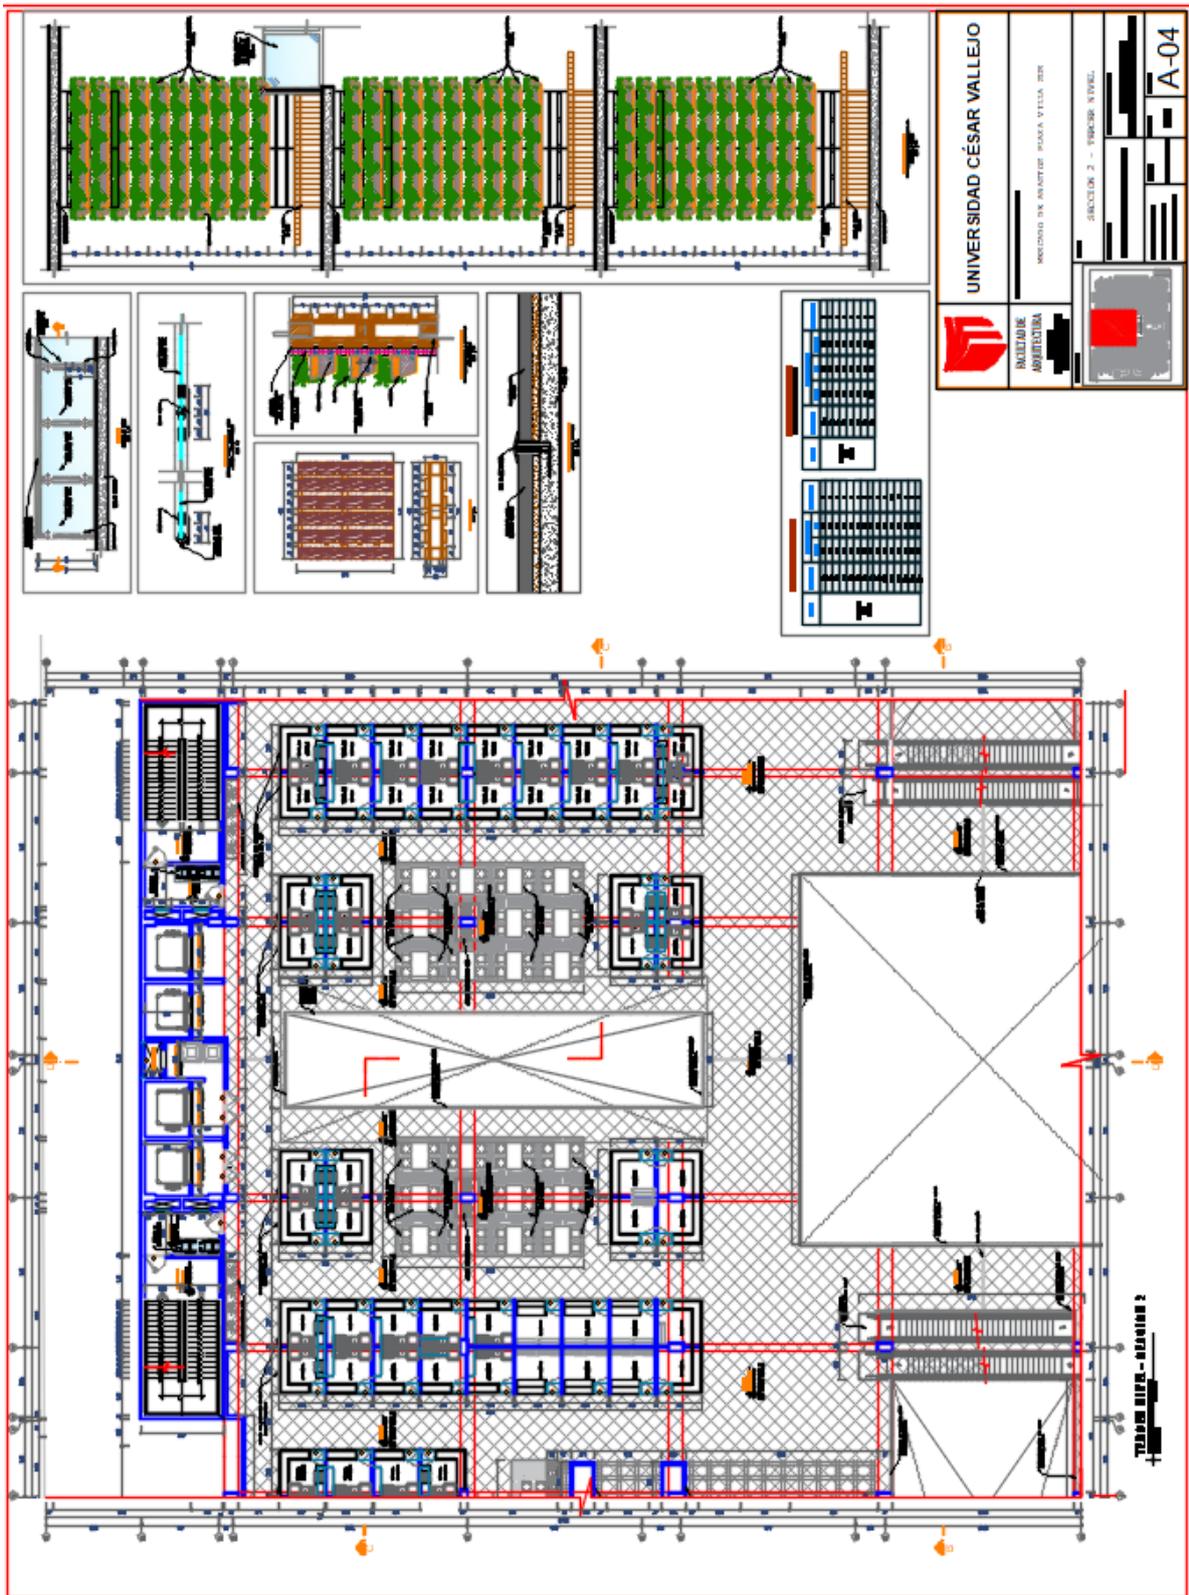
Plano de Arquitectura – Plano de secciones –tercer piso
